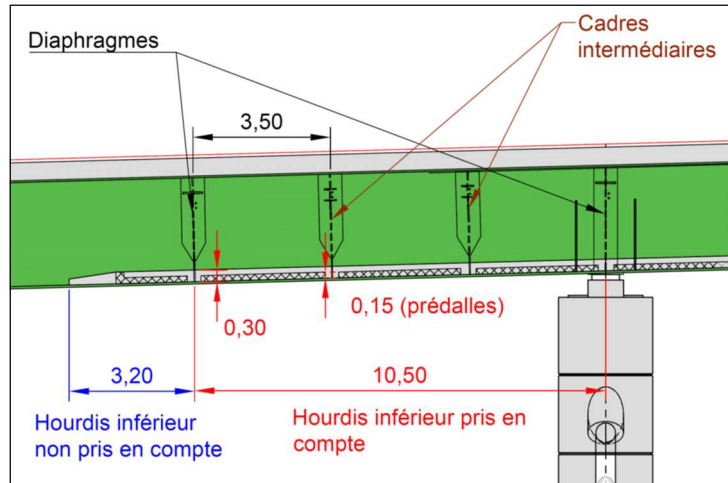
Coupe longitudinale d'une demi-zone DAM
